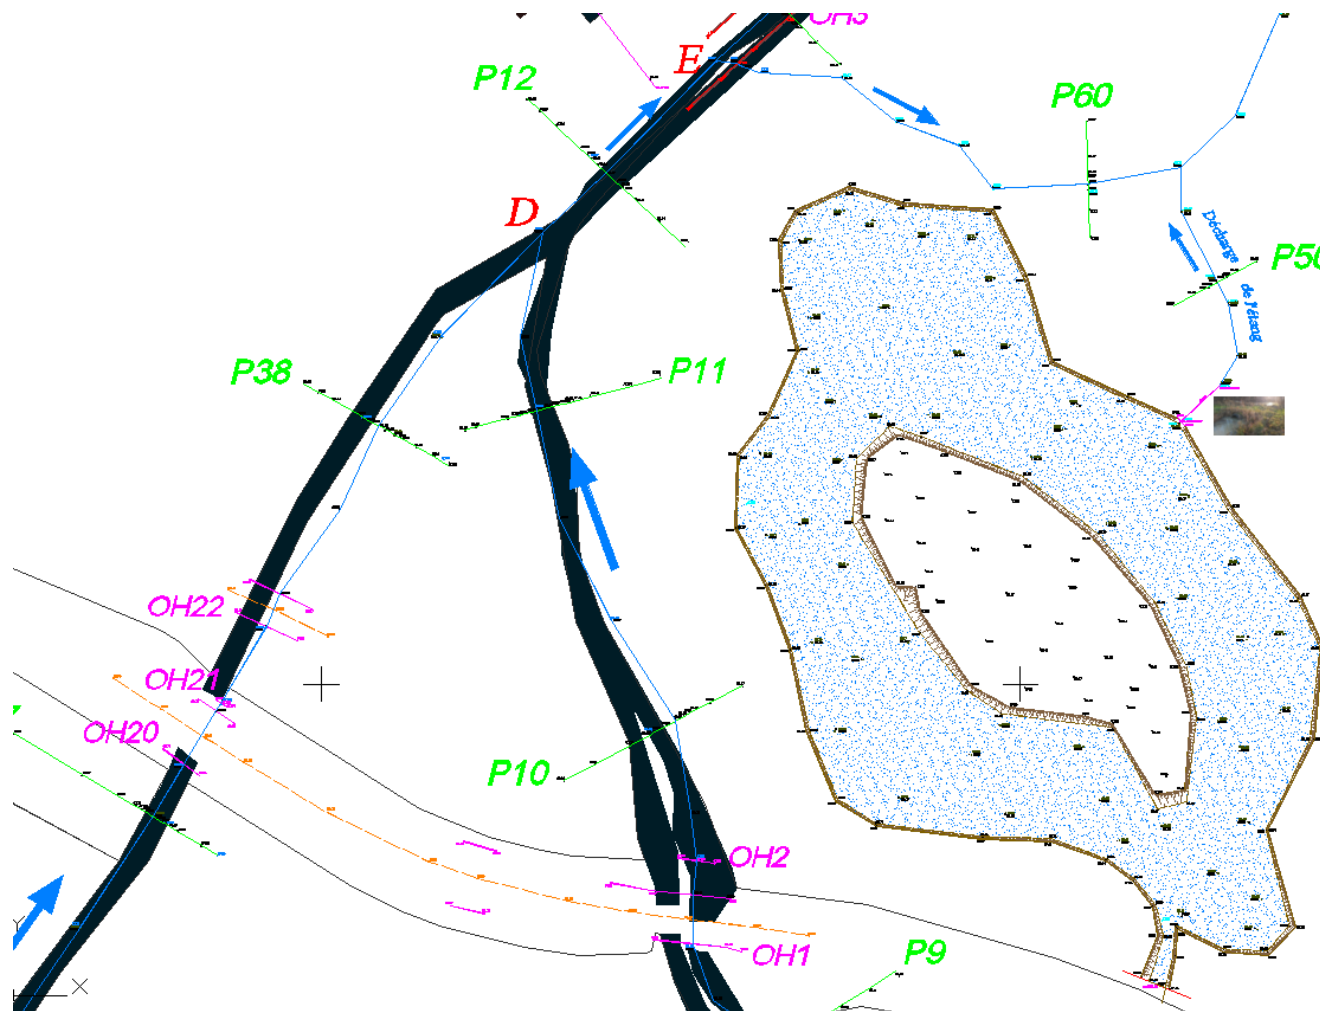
Extrait de la vue en plan du plan d'eau en rive droite du Lunain en amont de la maison des Pêcheurs
